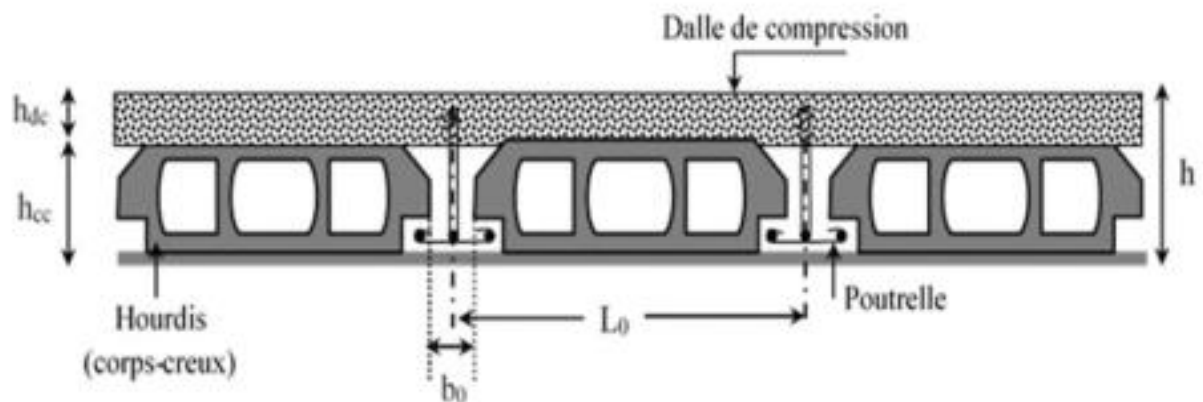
coupe transversales d'un plancher à corps creux
